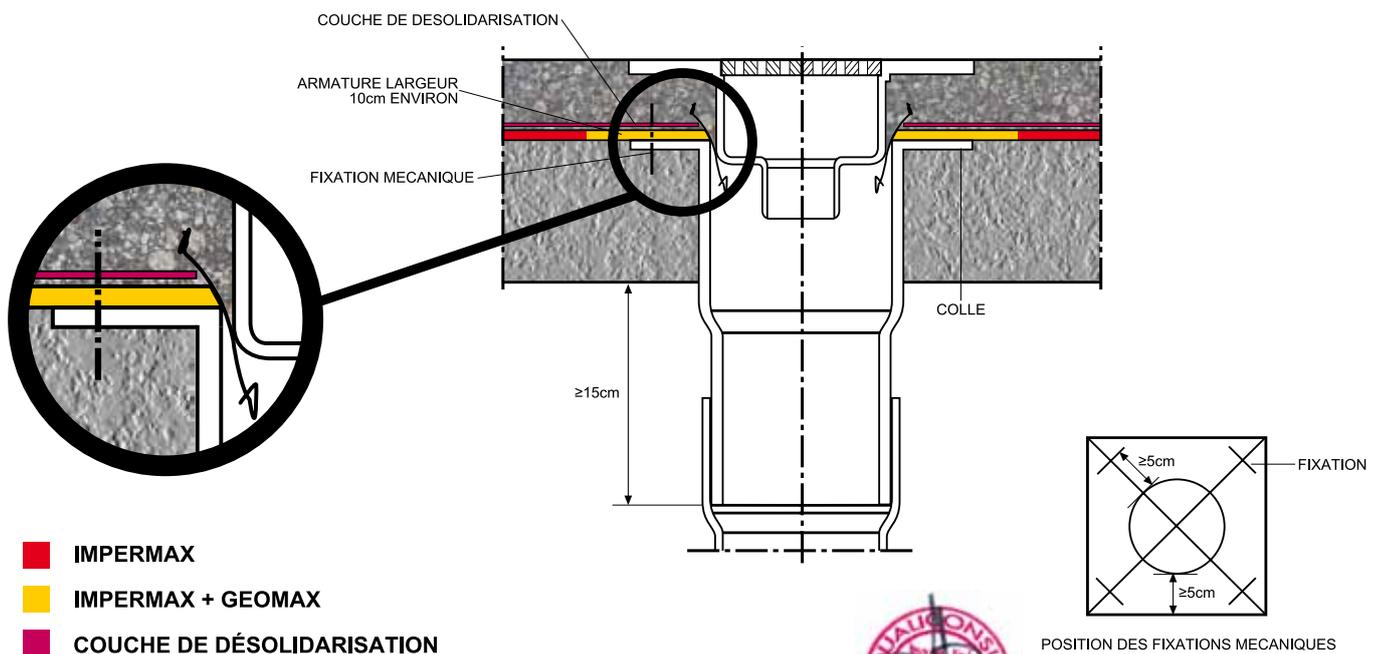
Raccordement sur avaloir cas d'IMPERMAX sous carrelage collé
